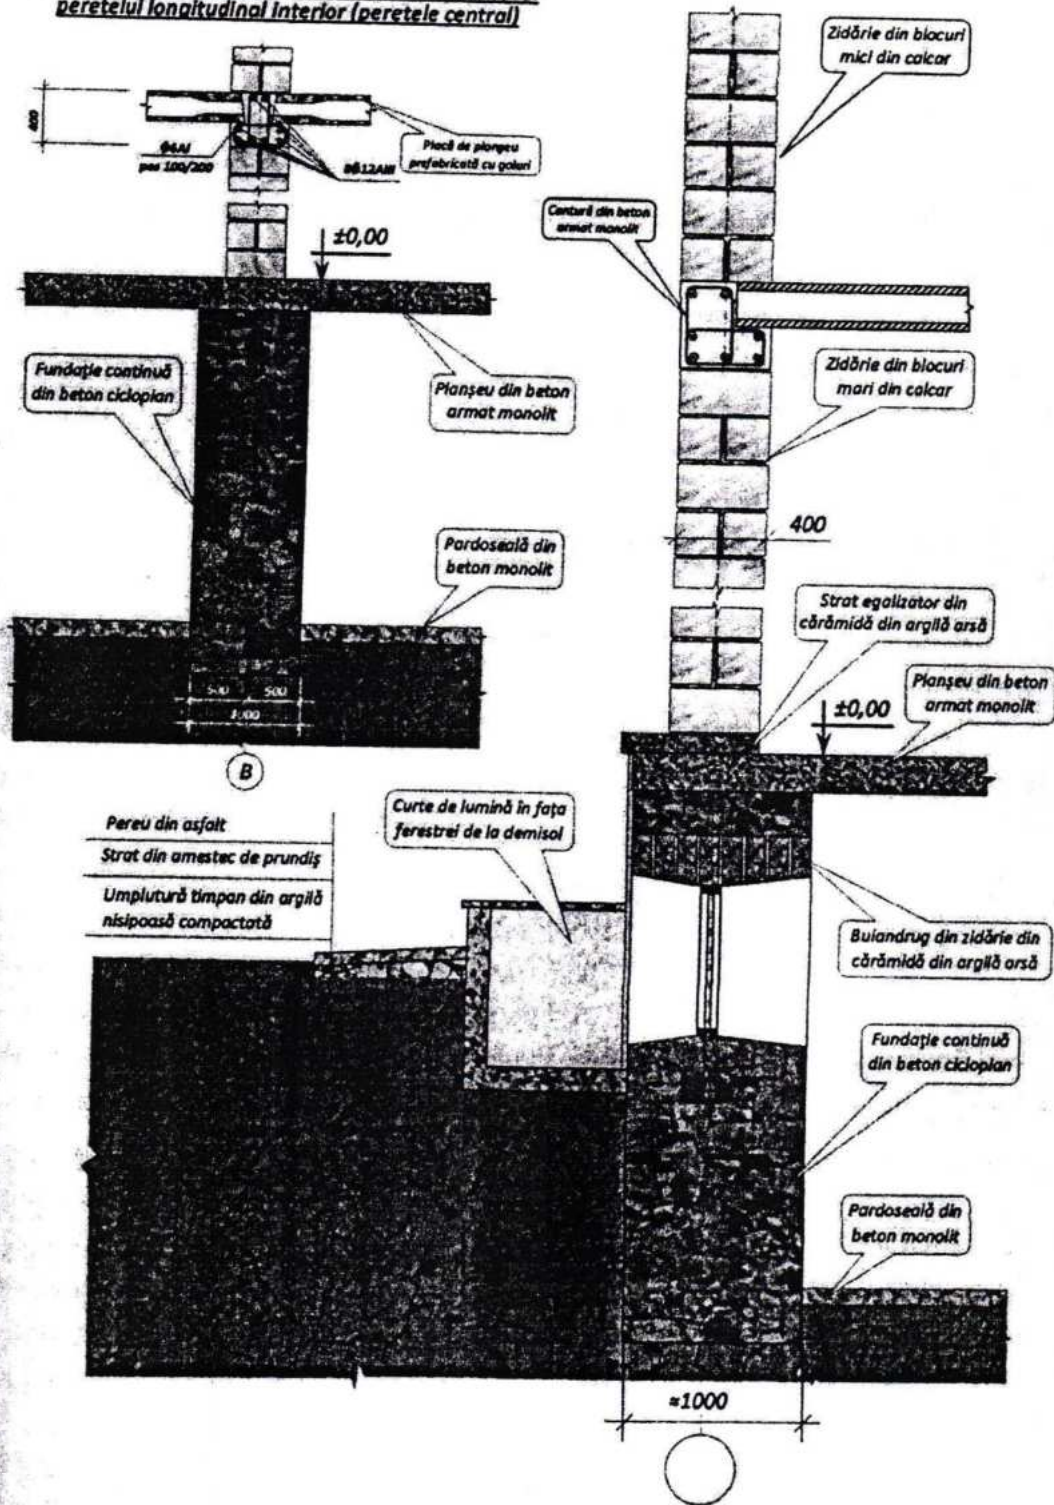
Aspectul planșeului realizat deasupra demisolului din beton armat monolit.
